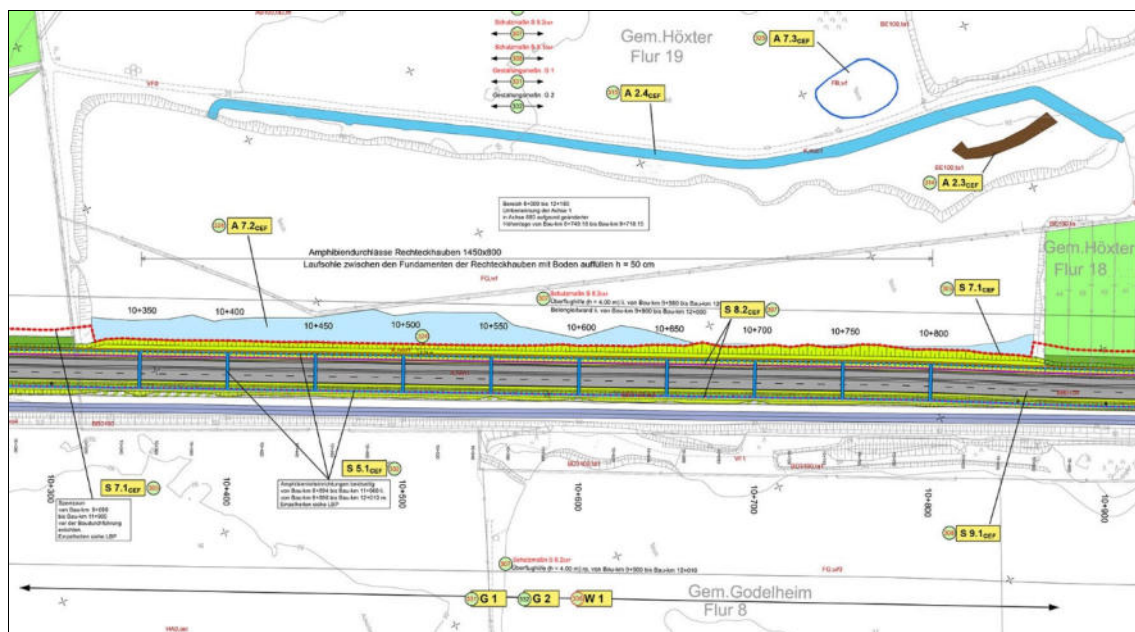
Ausschnitt aus dem Maßnahmenlageplan des LBP zu FR 3 + FR 5.
